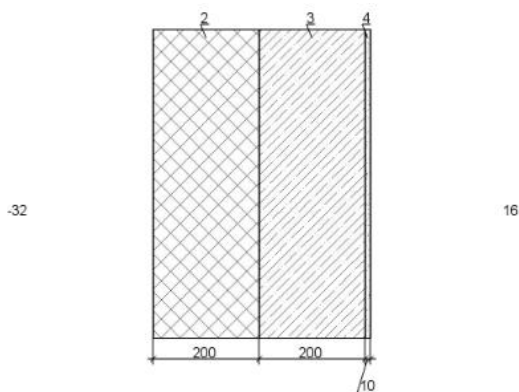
Разрез перекрытия панель толщиной 410 мм
